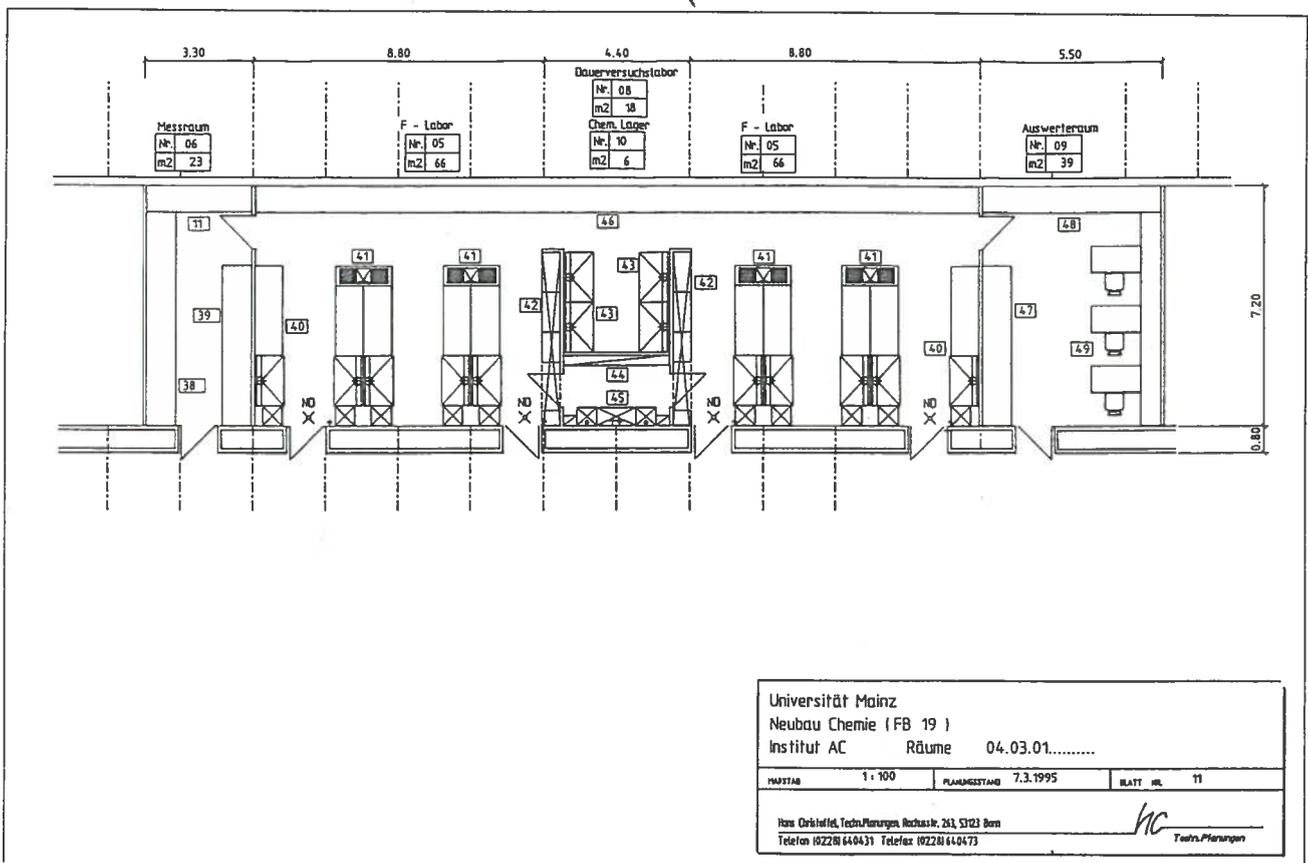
Grundriß Laborraumgruppe (Neubauplanung Universität Mainz)
